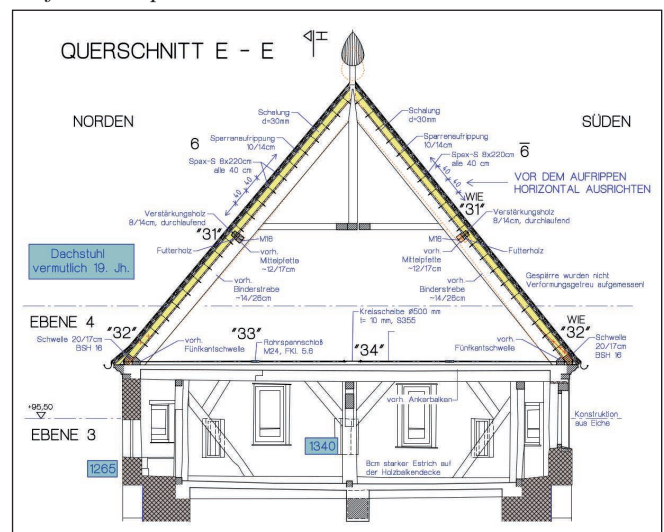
Querschnitt E-E Dachstuhlverstärkung – Maßnahmenplan.
